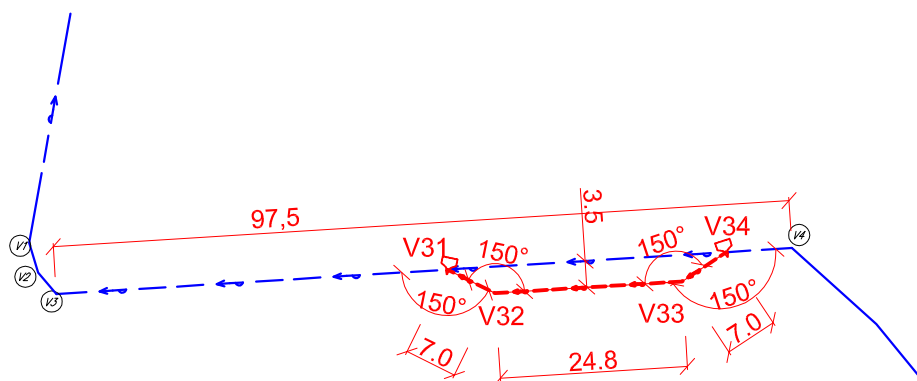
## DETAIL ÚPRAVY ZAÚSTĚNÍ ODKALOVACÍHO POTRUBÍ DN 150
